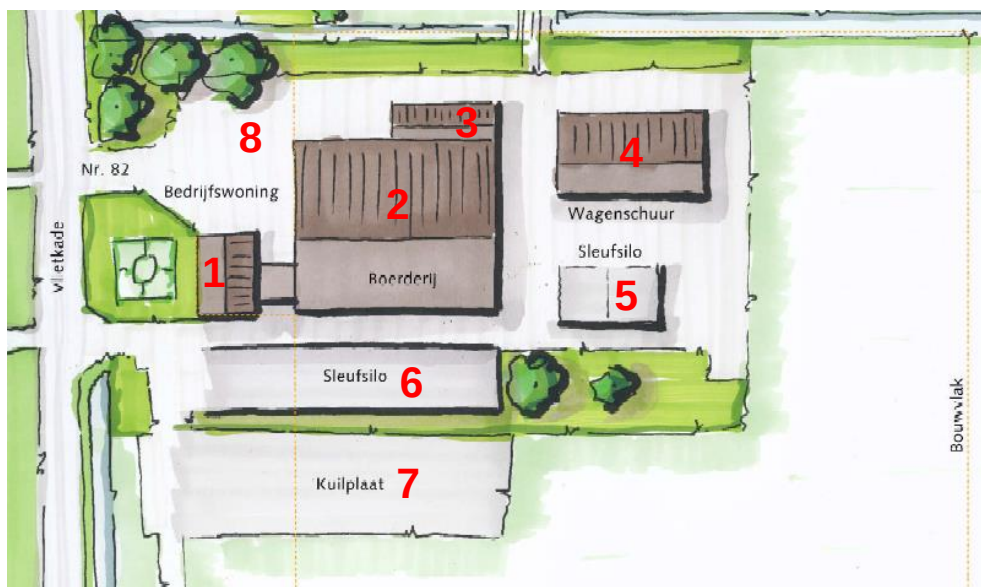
Landschappelijke structuur ter plaatse van het plangebied
